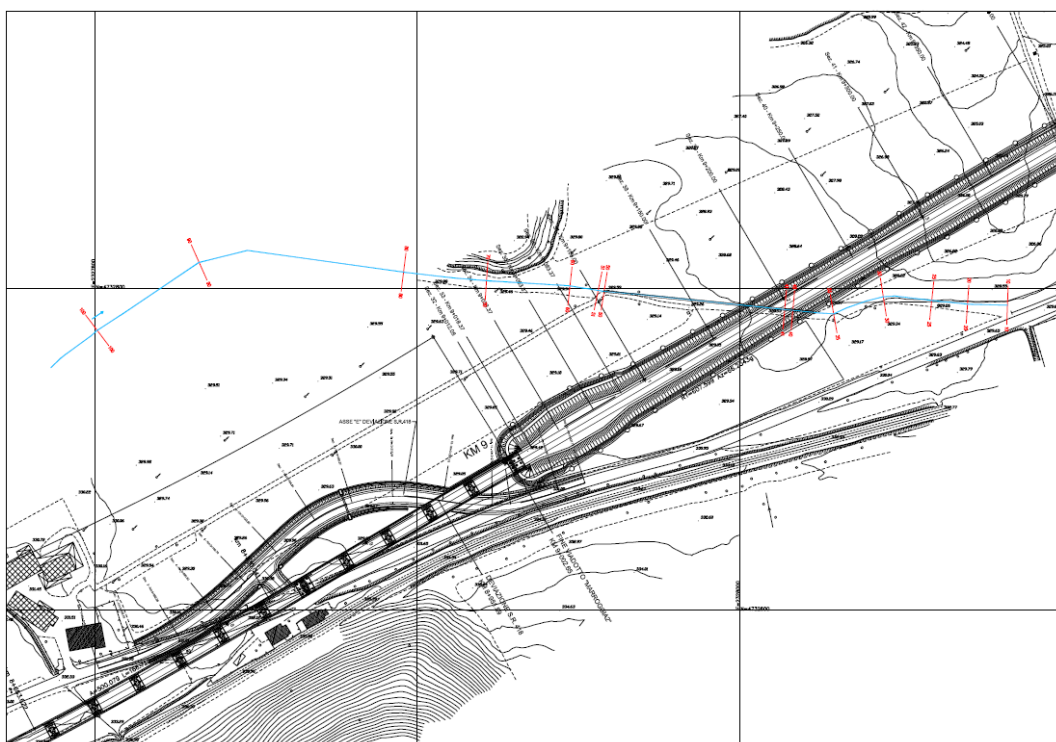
Planimetria dell'intervento e sezioni trasversali d'alveo del Canale dei Molini I.
